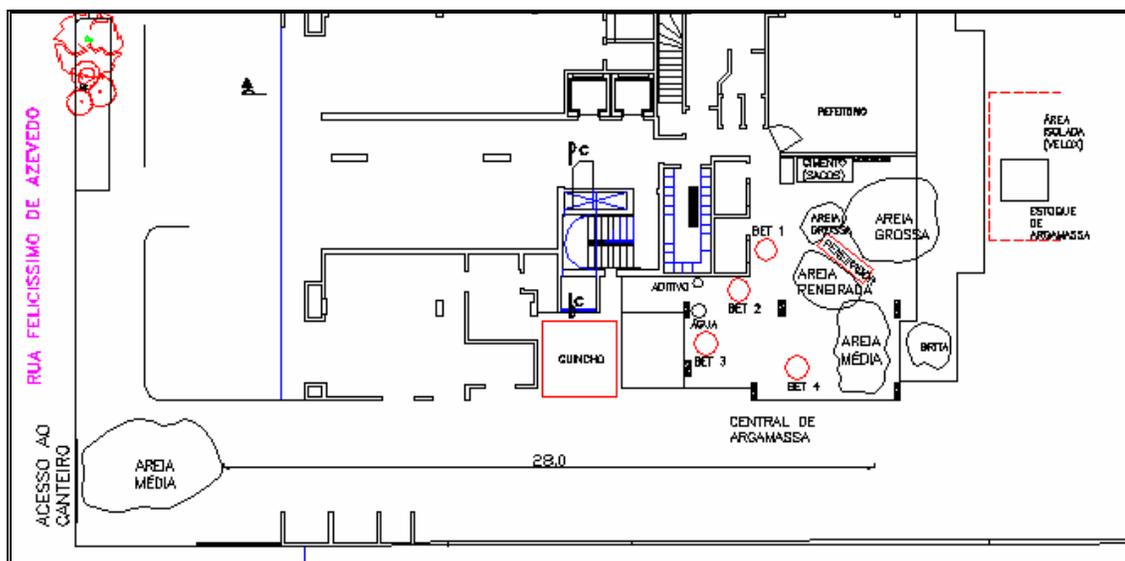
Central de produção de argamassa no pavimento térreo do empreendimento C
